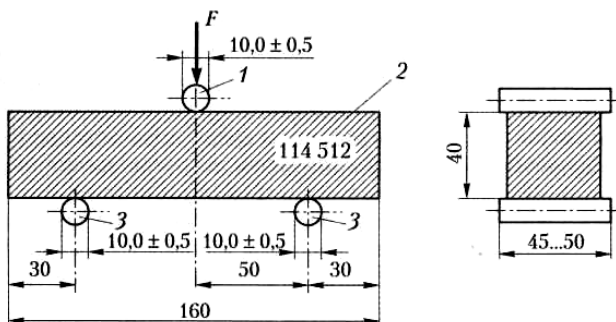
Схема расположения образца-балочки при испытании на изгиб: 1 - нагруженный элемент; 2 - образец-балочка; 3 - опоры
